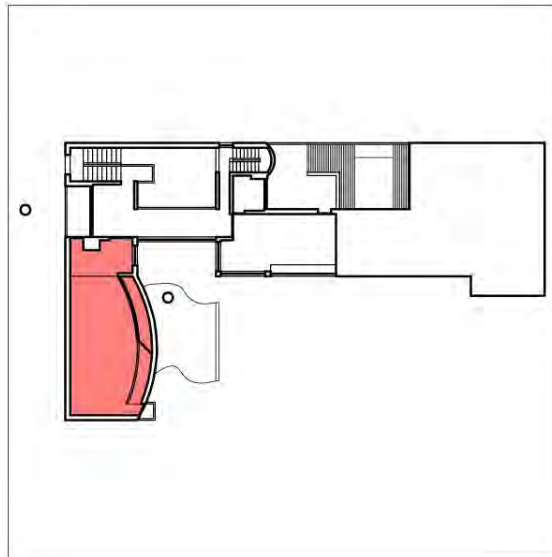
Villa La Roche, Planta de Localização da galleria (Ilustração nossa)
